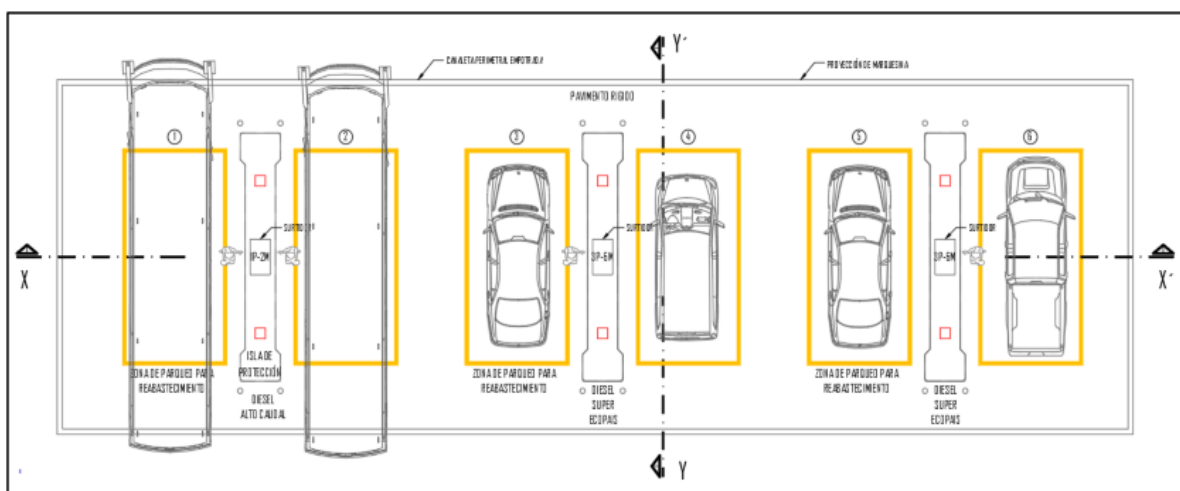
Surtidores. Fuente: Plano arquitectónico
